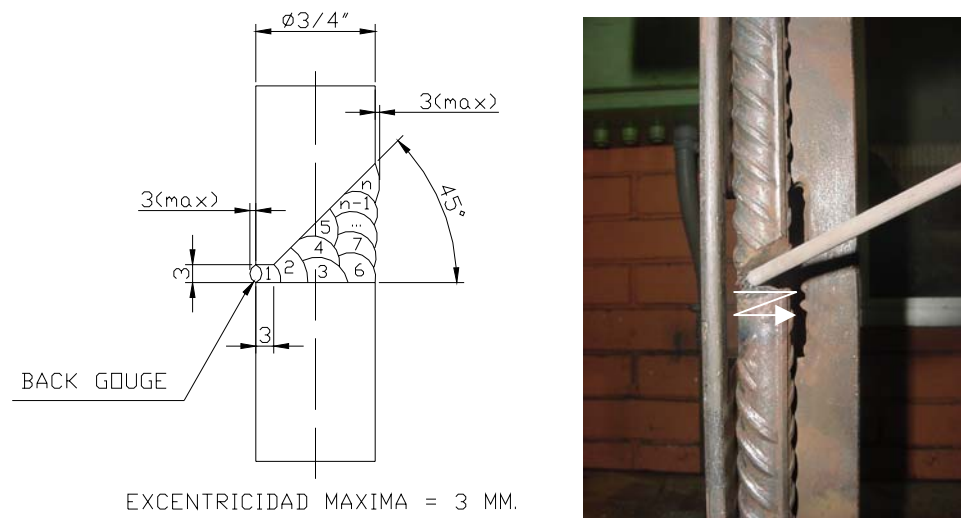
Detalle geométrico y técnica de soldeo para la posición 1G
